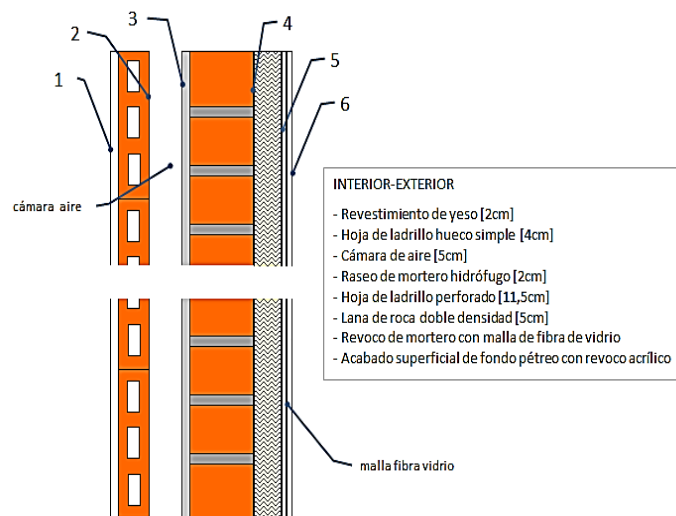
Solución constructiva del SATE aplicado al muro base
